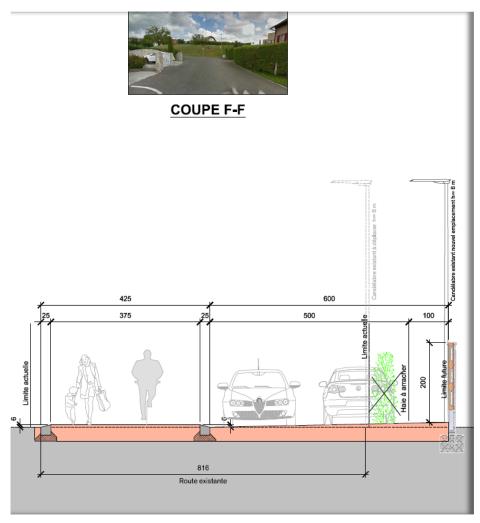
Coupe F sur parcelle RF n° 950 (élargissement du passage de la Blancherie
